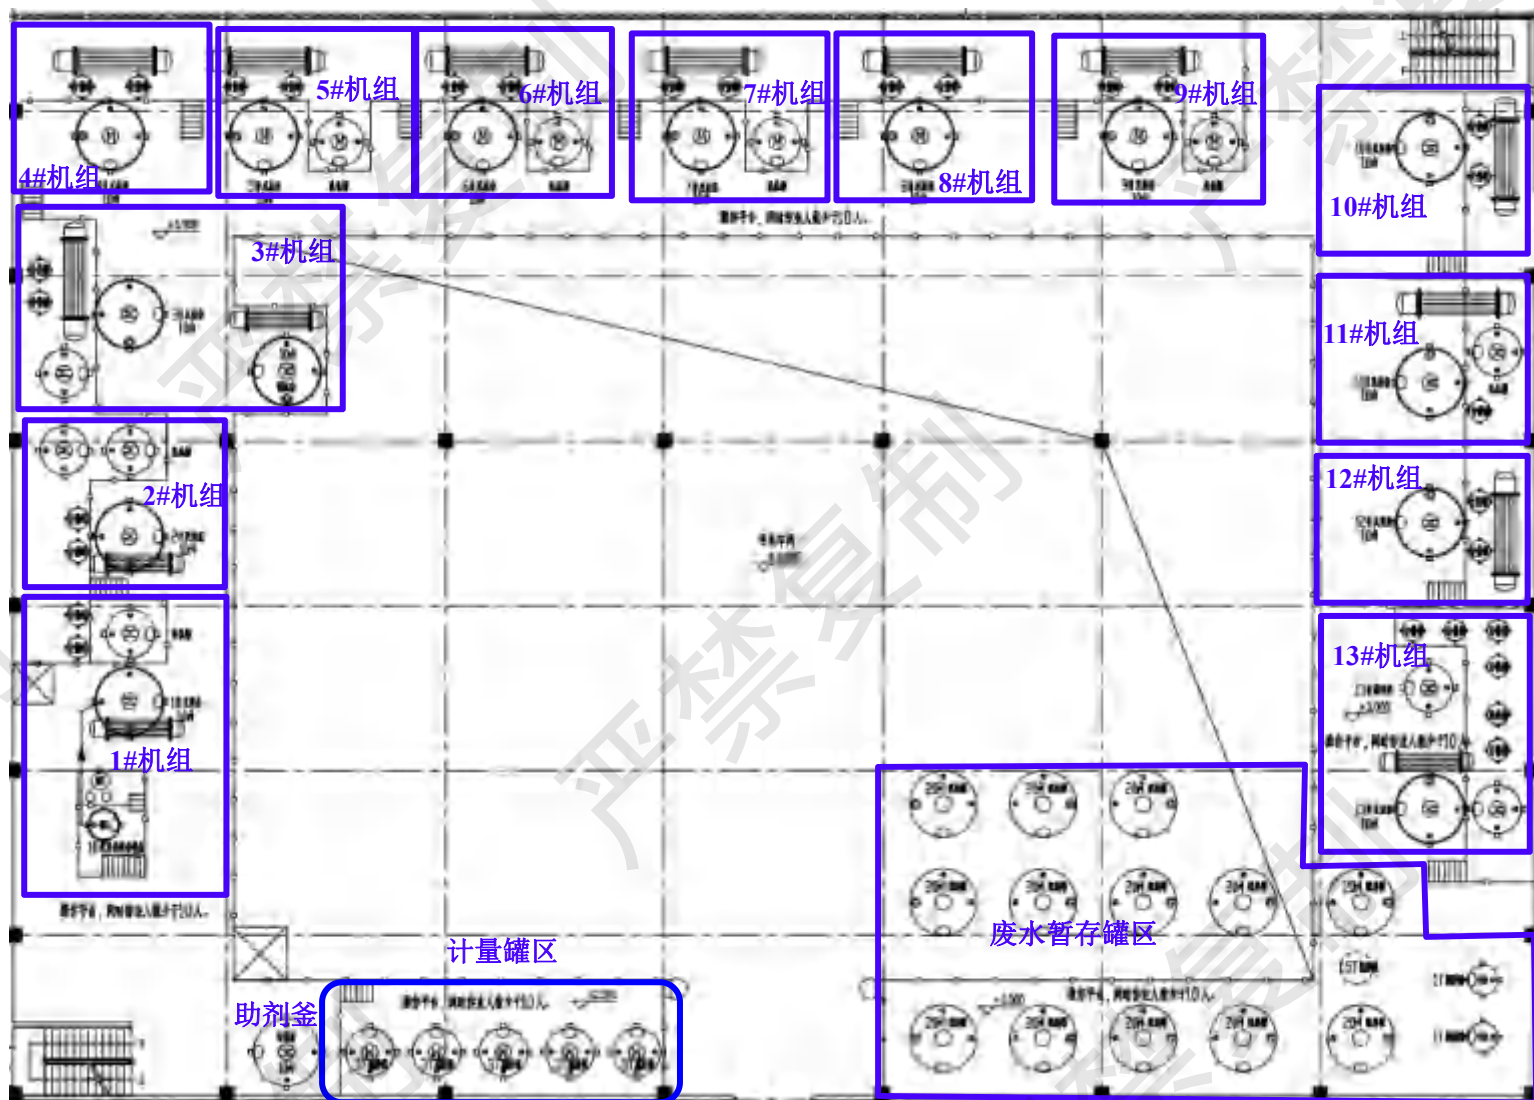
技改扩建后车间（厂房 D-胶水合成车间）平面布置图
